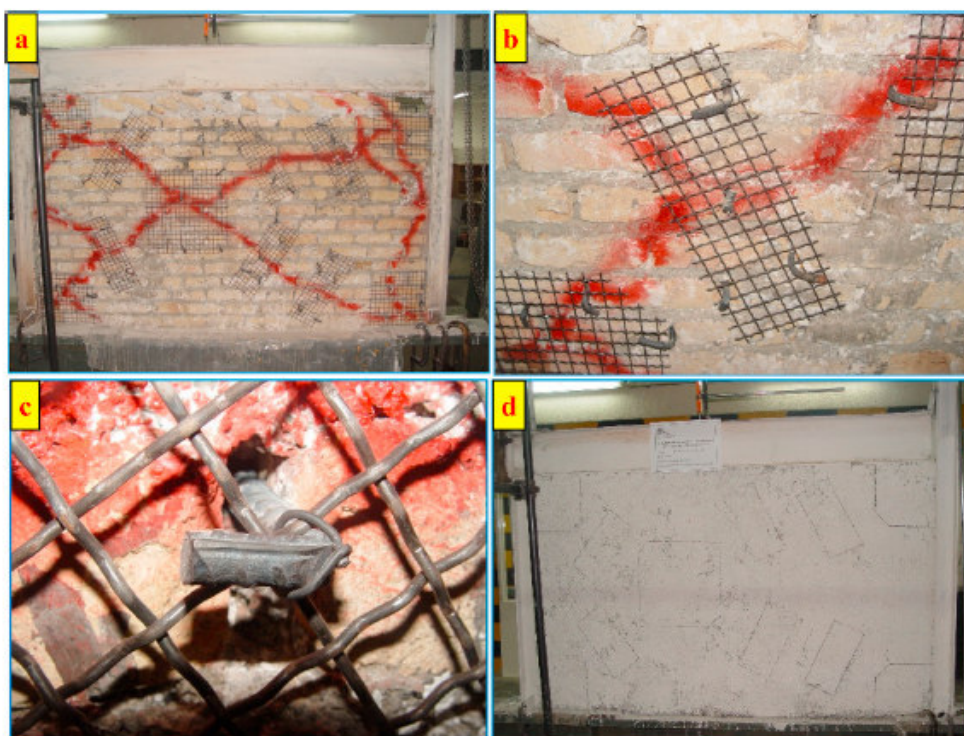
a) Instalación de la malla metálica sobre las grietas, b) anclaje de la malla con ganchos, c) Fijación de malla y gancho con alambre fino, d) Enlucido del relleno con yeso cementante.
